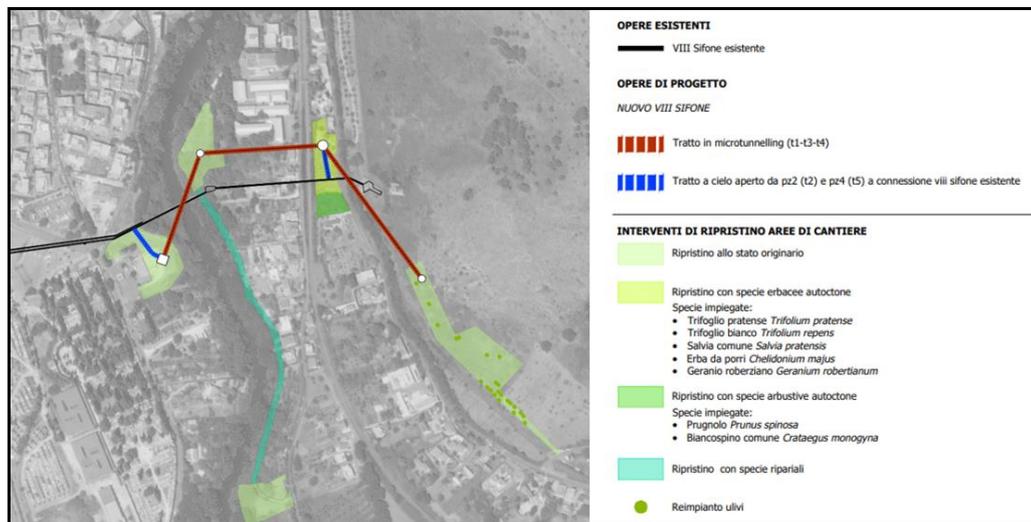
Stralcio della tavola "planimetria degli interventi di ripristino"
